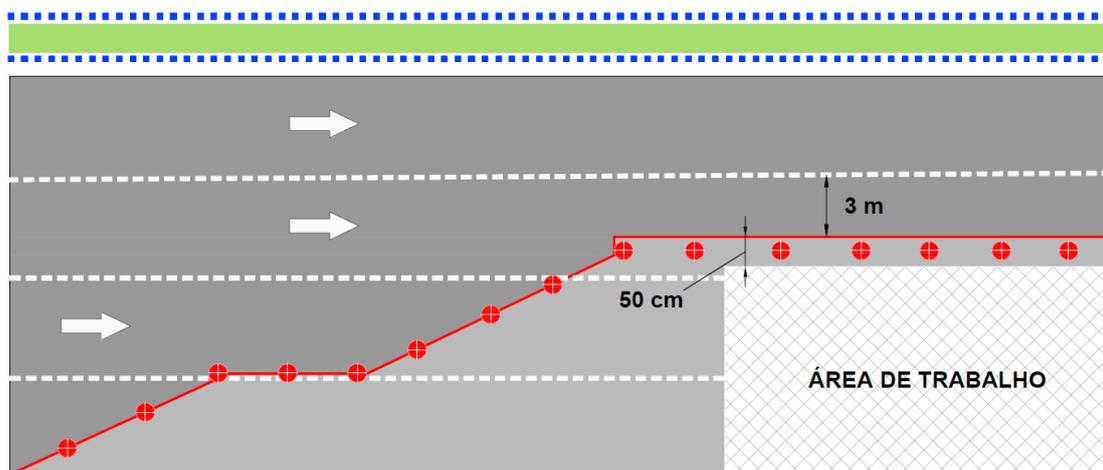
Posicionamento de dispositivos de canalização – Pista com 4 Faixas (caso 1)
